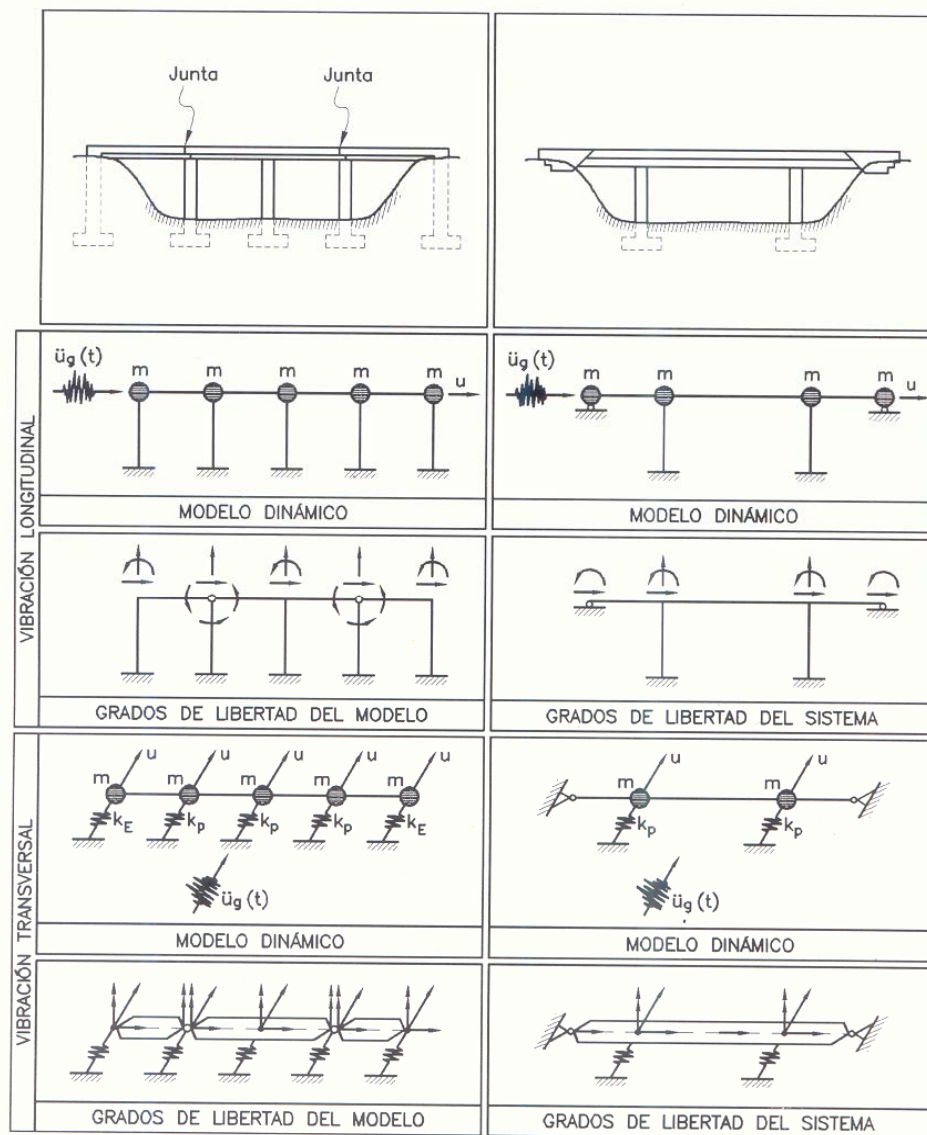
Ejemplos de puentes modelados en sentido longitudinal y transversal
